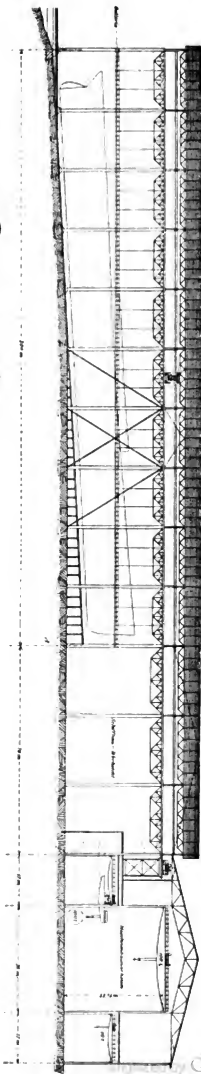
Heilige, Ausrüstungsbassin und Werkstätten mit Bedachung und Laufkränen der New-York Shipbuilding Co., Camden, N. J.
